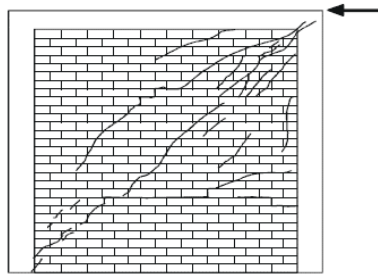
Ensayo en voladizo de un muro de mampostería confinada (Meli, 1979)
